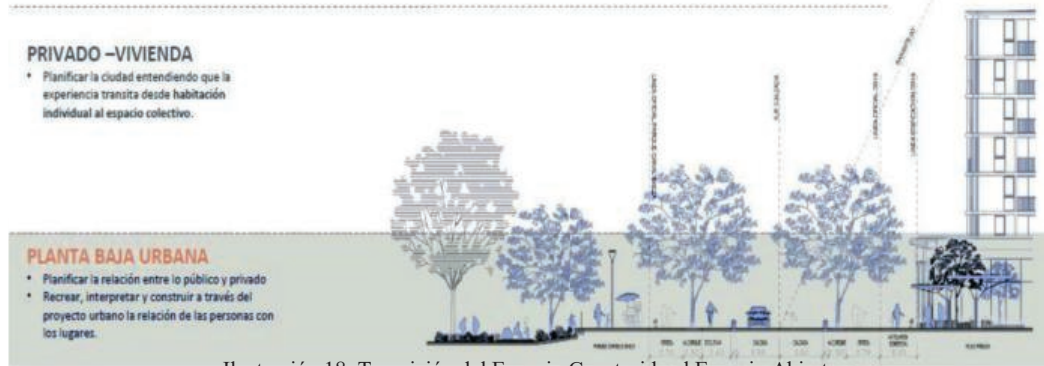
Transición del Espacio Construido al Espacio Abierto
